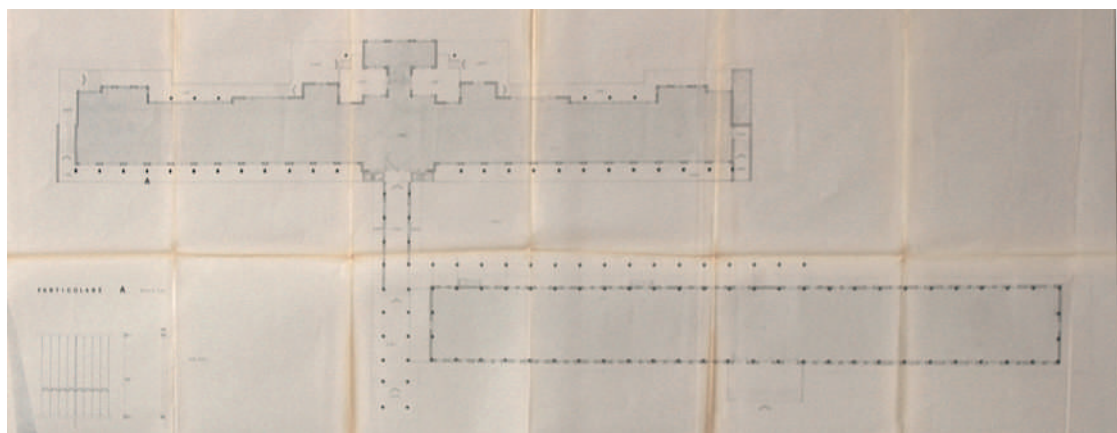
Raffaele Argo, Progetto di completamento e ristrutturazione dell'Ospedale, 2° lotto. Monoblocchi A e B, pianta sistemazione esterna. Pianta, scala 1:100, 20 marzo 1972 [da AOAPPCNa].
